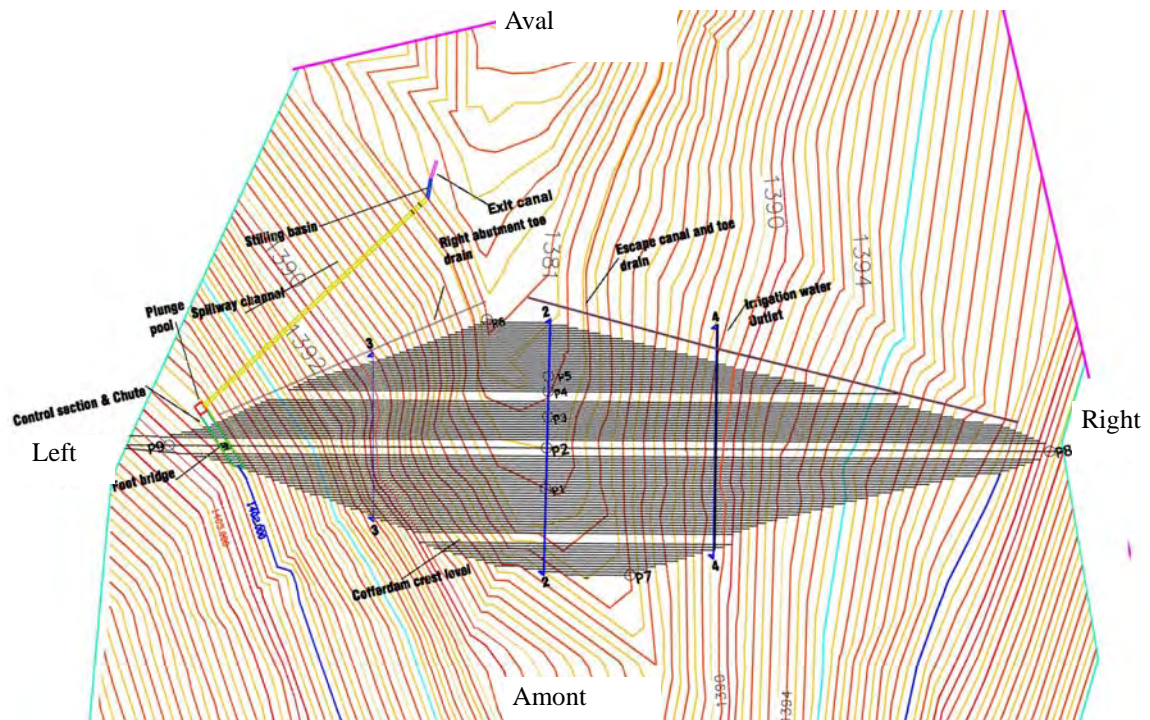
Plan de barrage (Rapport de conception LWH)
